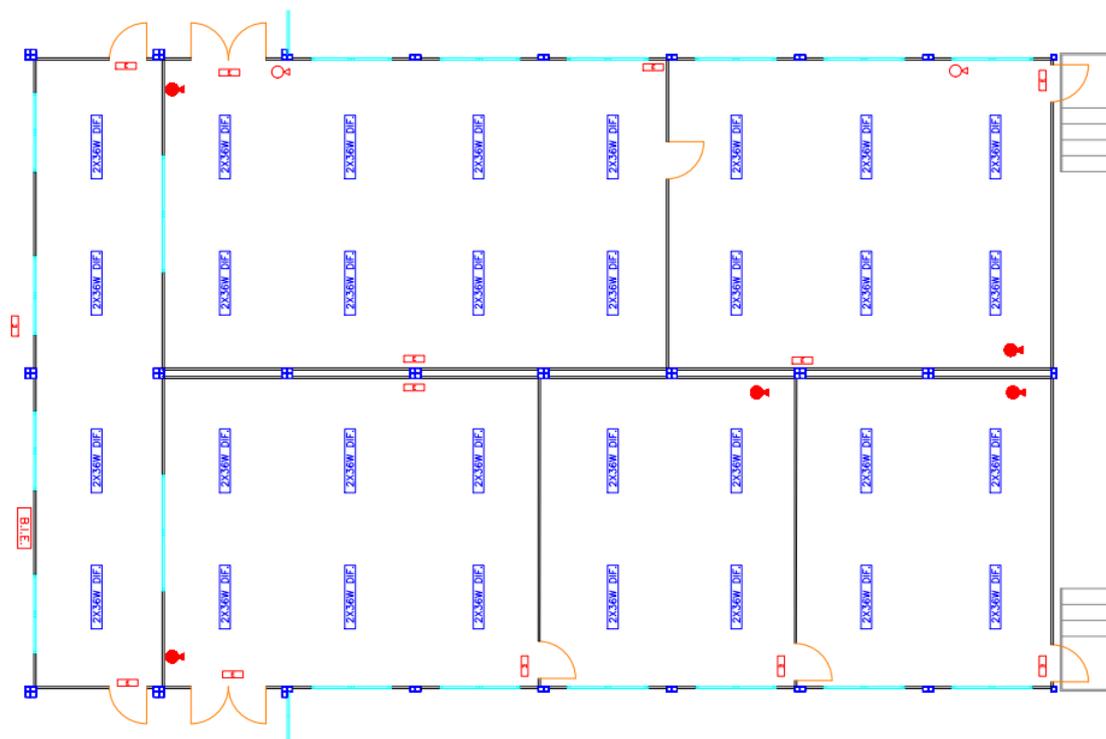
Extracto de plano planta baja de iluminación. Fuente: Universitat Politècnica de València
